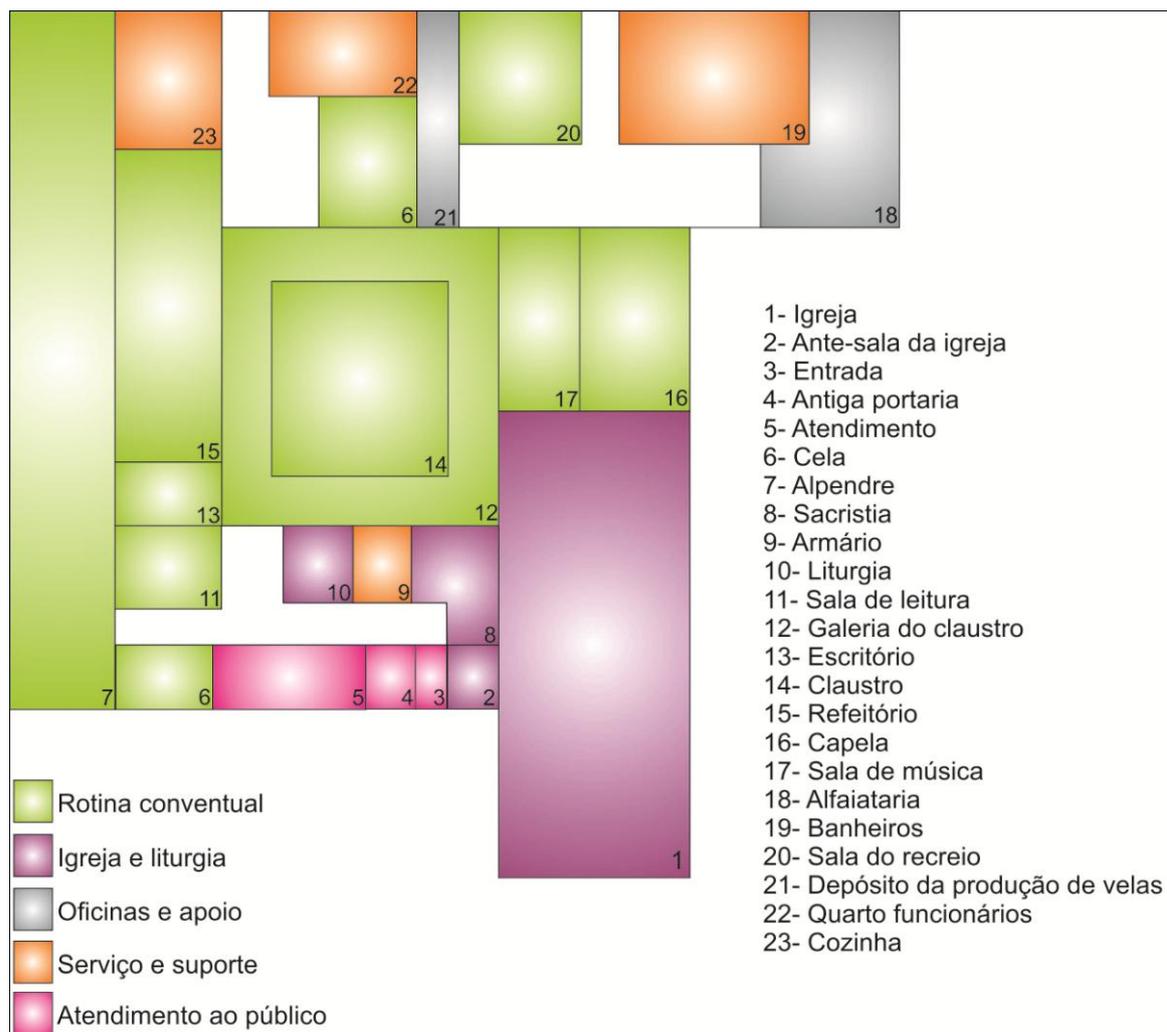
Planta esquemática do pavimento térreo do convento de Rodeio, sem escala.
